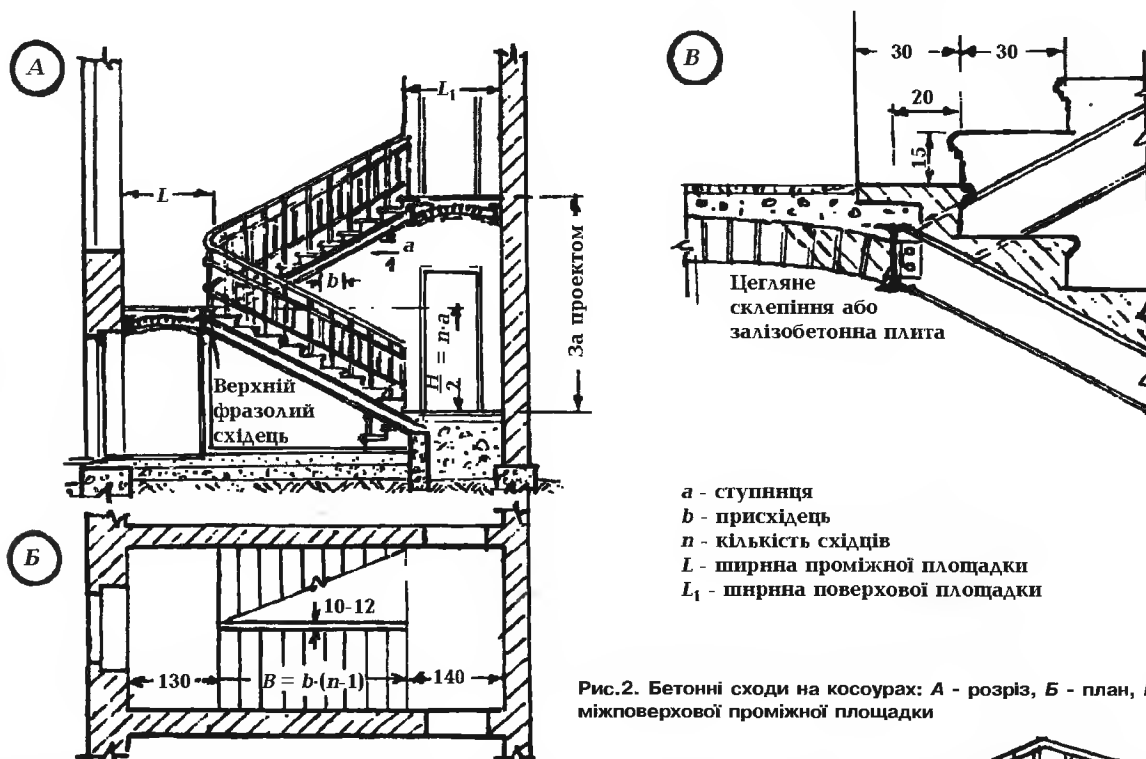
Бетонні сходи на косоурах: А - розріз, Б - план, В - деталь міжповерхової проміжної площадки
